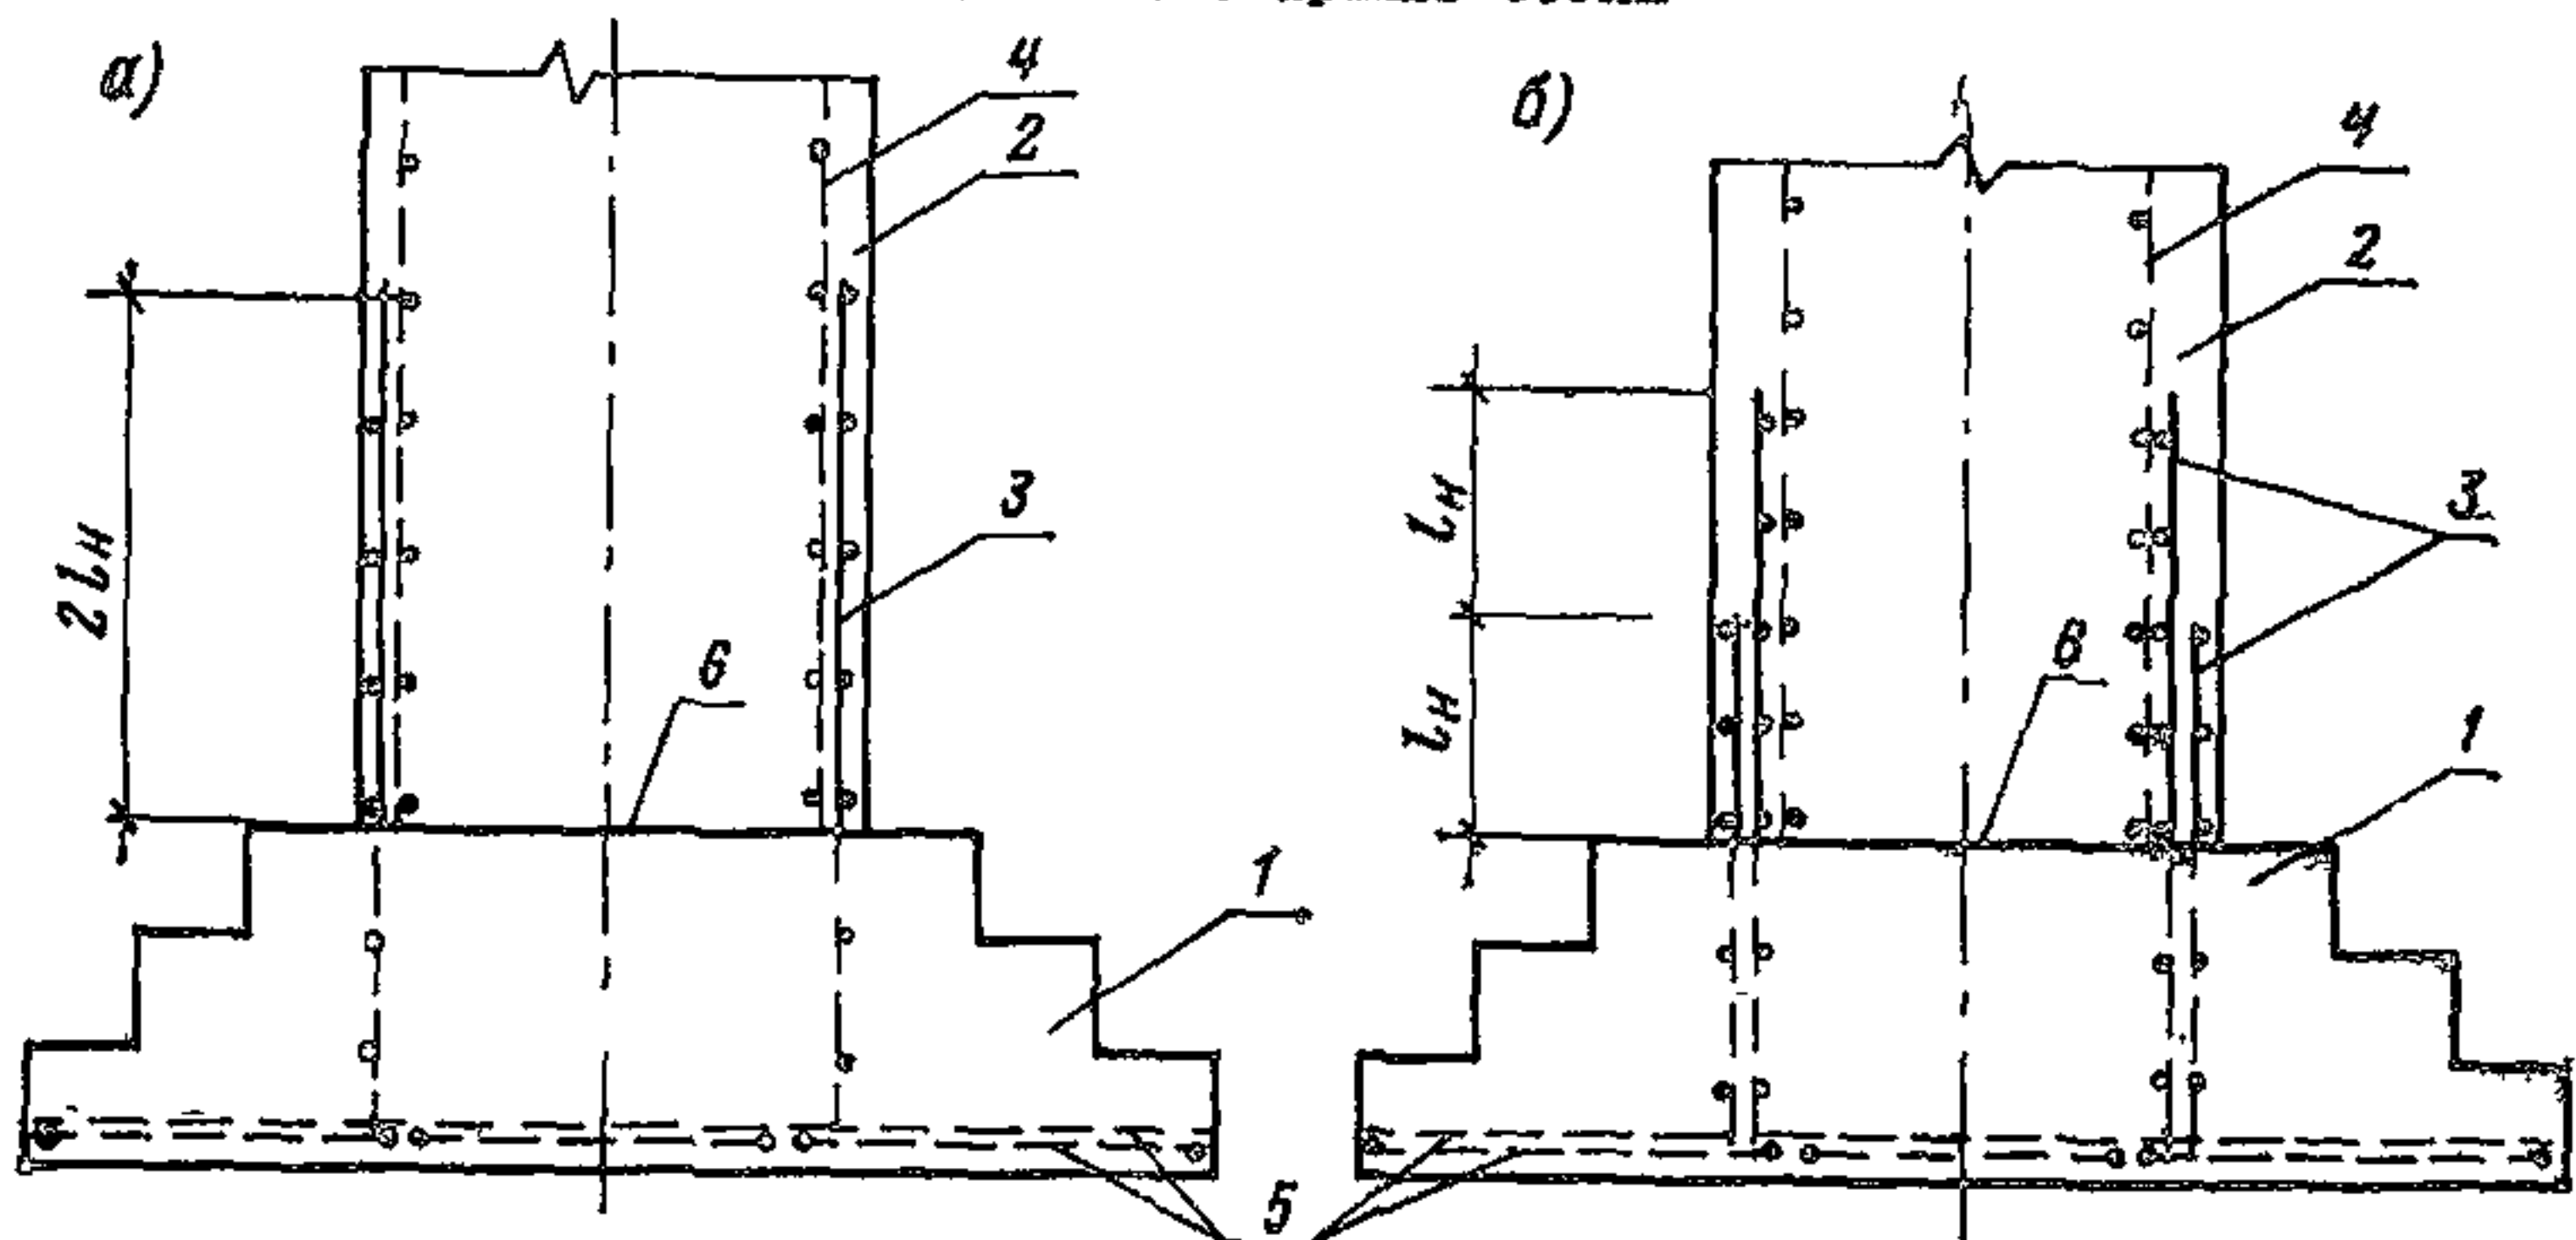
Устройство стыков растянутых стержней внахлестку в фундаментах колонн при раздельном бетонировании ступенчатой части фундамента и подколонника
